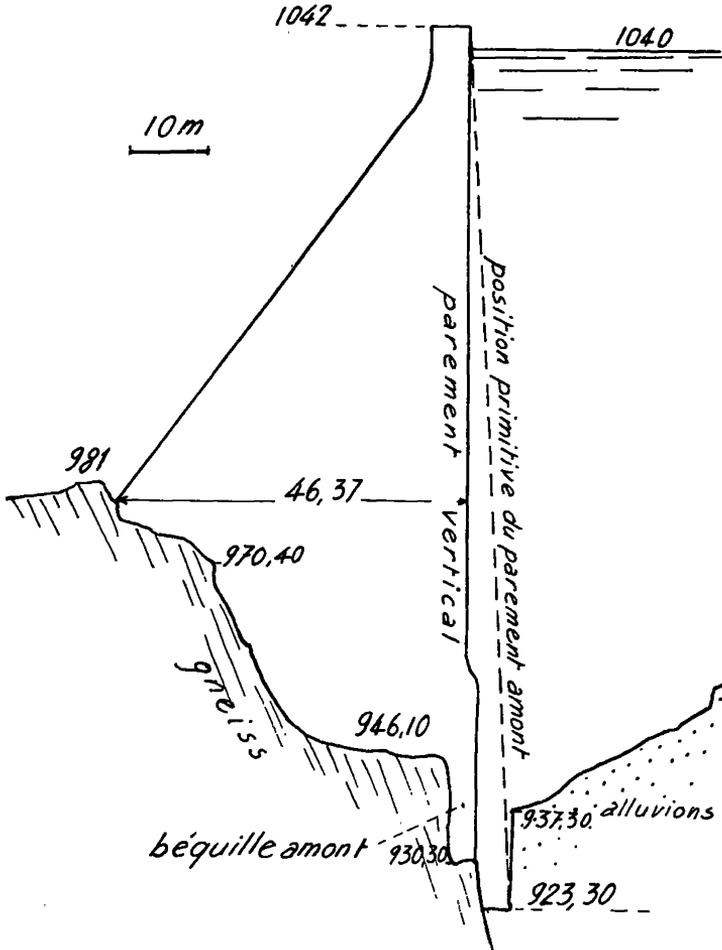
COUPE TRANSVERSALE DU BARRAGE (profil 13).
